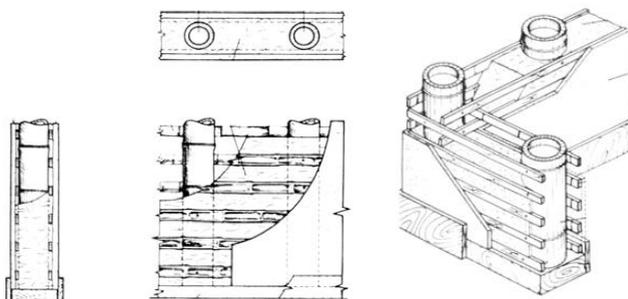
Detalhes construtivos dos painéis preenchidos com barro.
